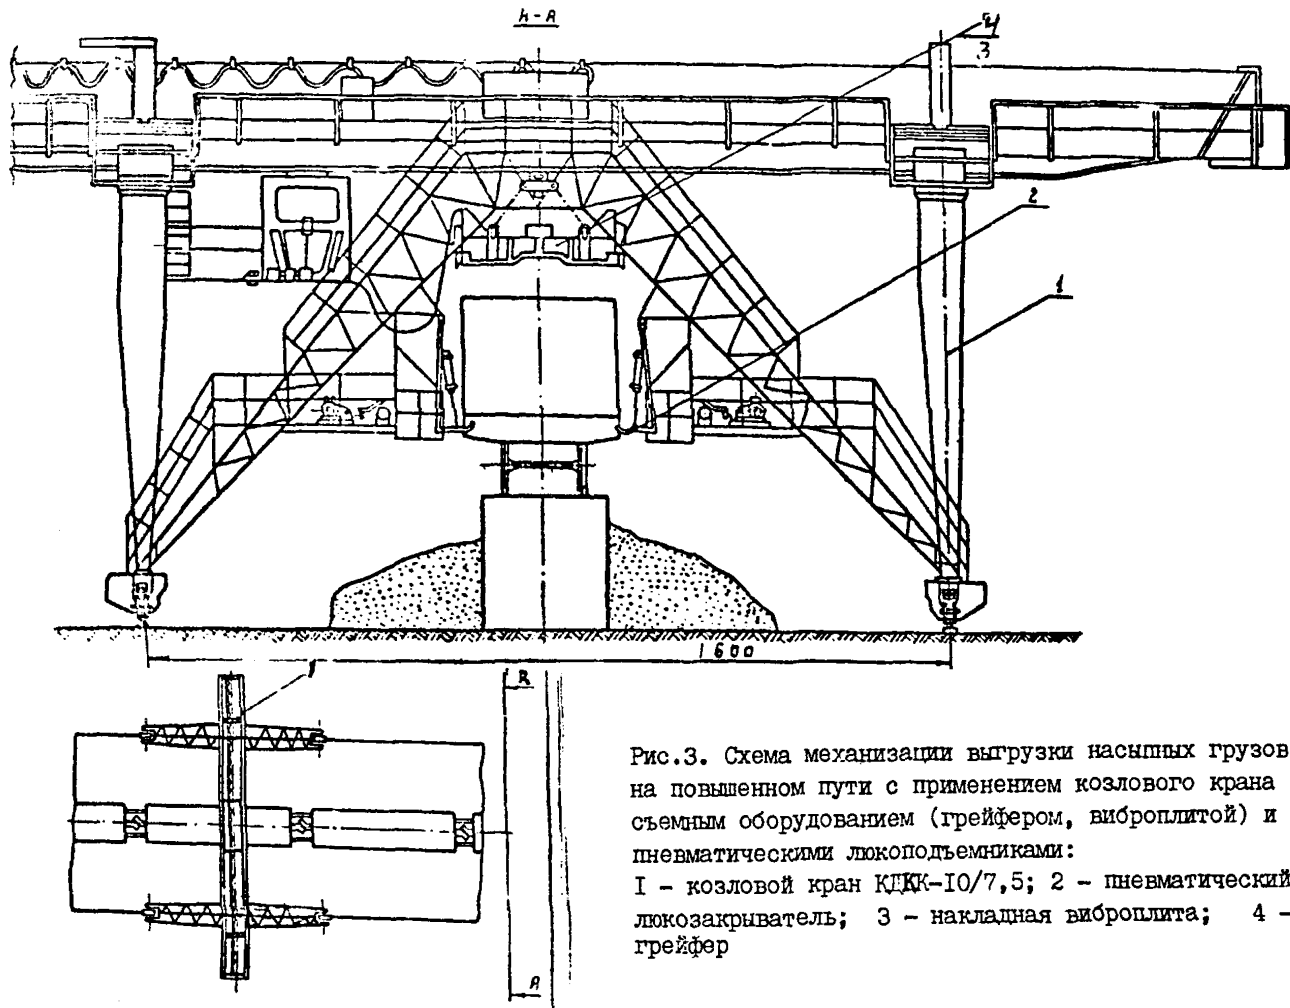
Схема механизации выгрузки насыпных грузов на повышенном пути с применением козлового крана со съемным оборудованием (грейфером, виброплитой) и пневматическими локоподъемниками:
